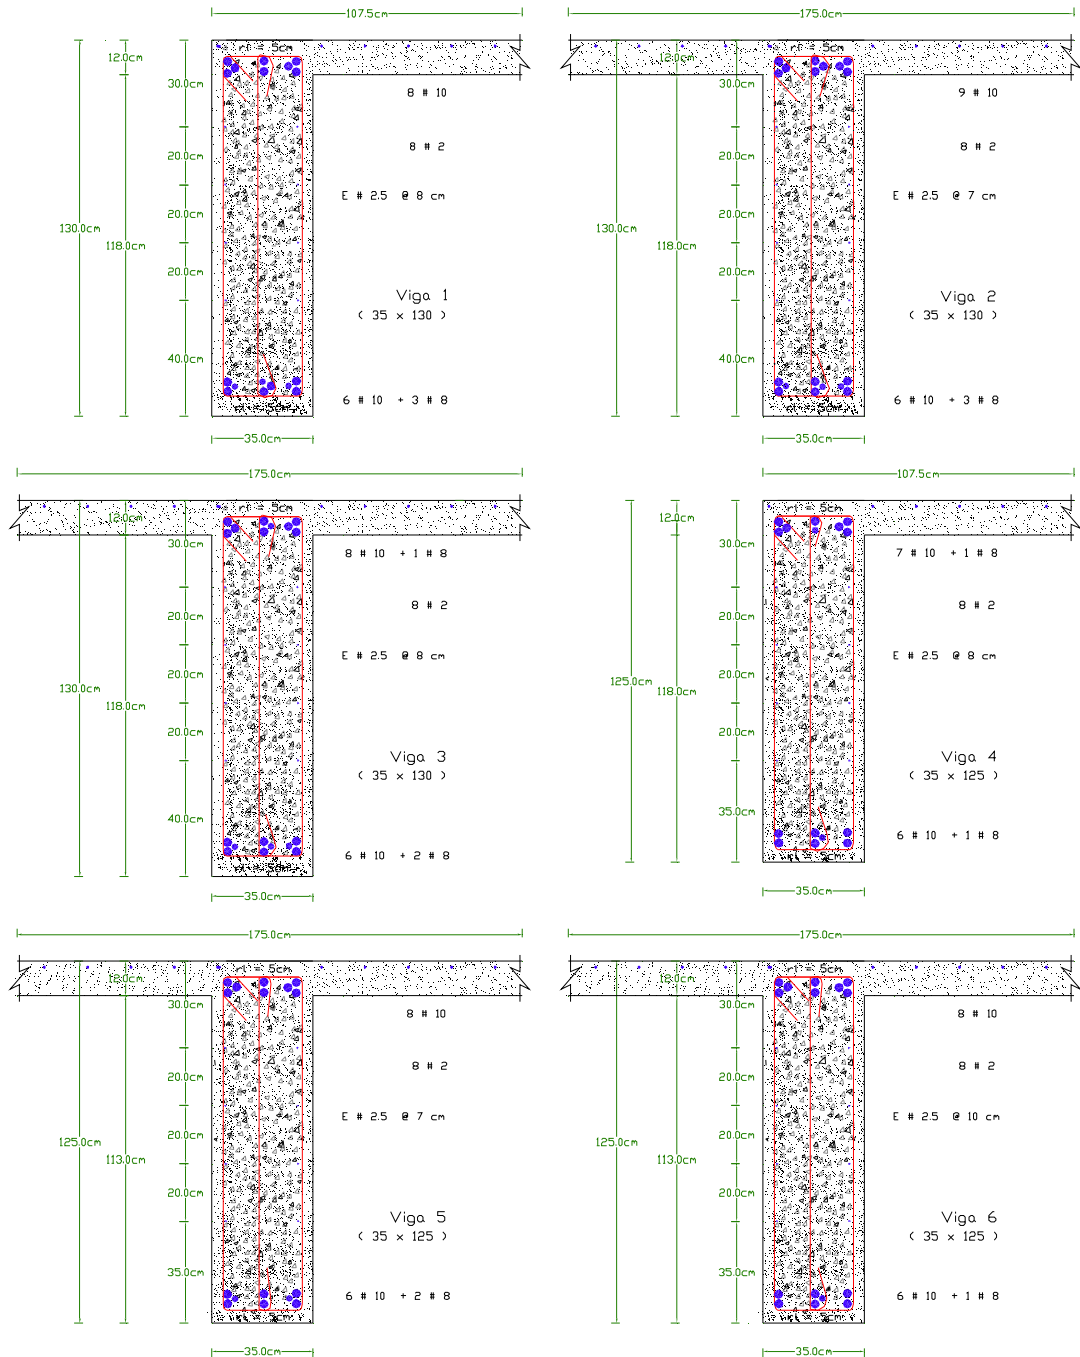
Dimensiones y armado de vigas, edificio III_15
